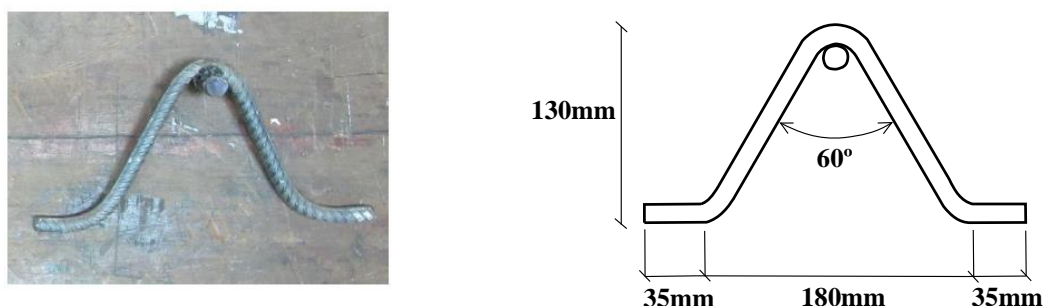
Geometria idealizada para conector treliçado (Modificado de BARBOSA, 2016).
